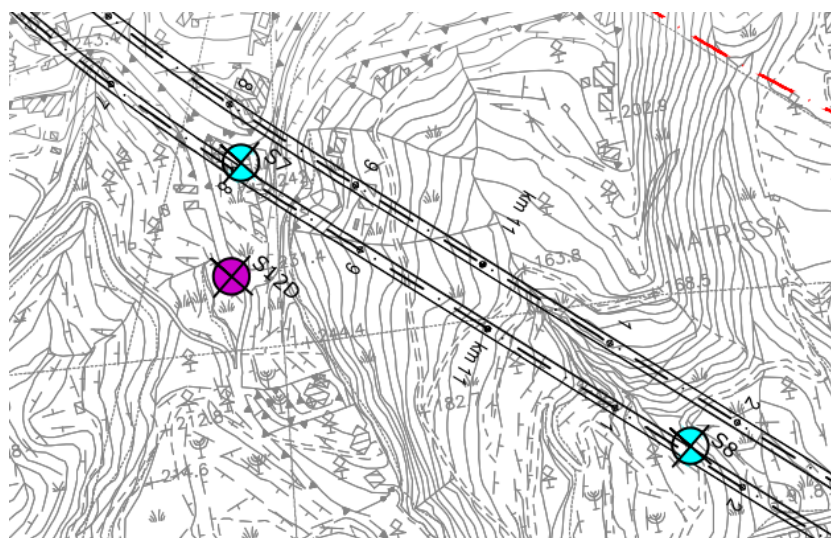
Planimetria con ubicazione dei sondaggi S7 e S8
